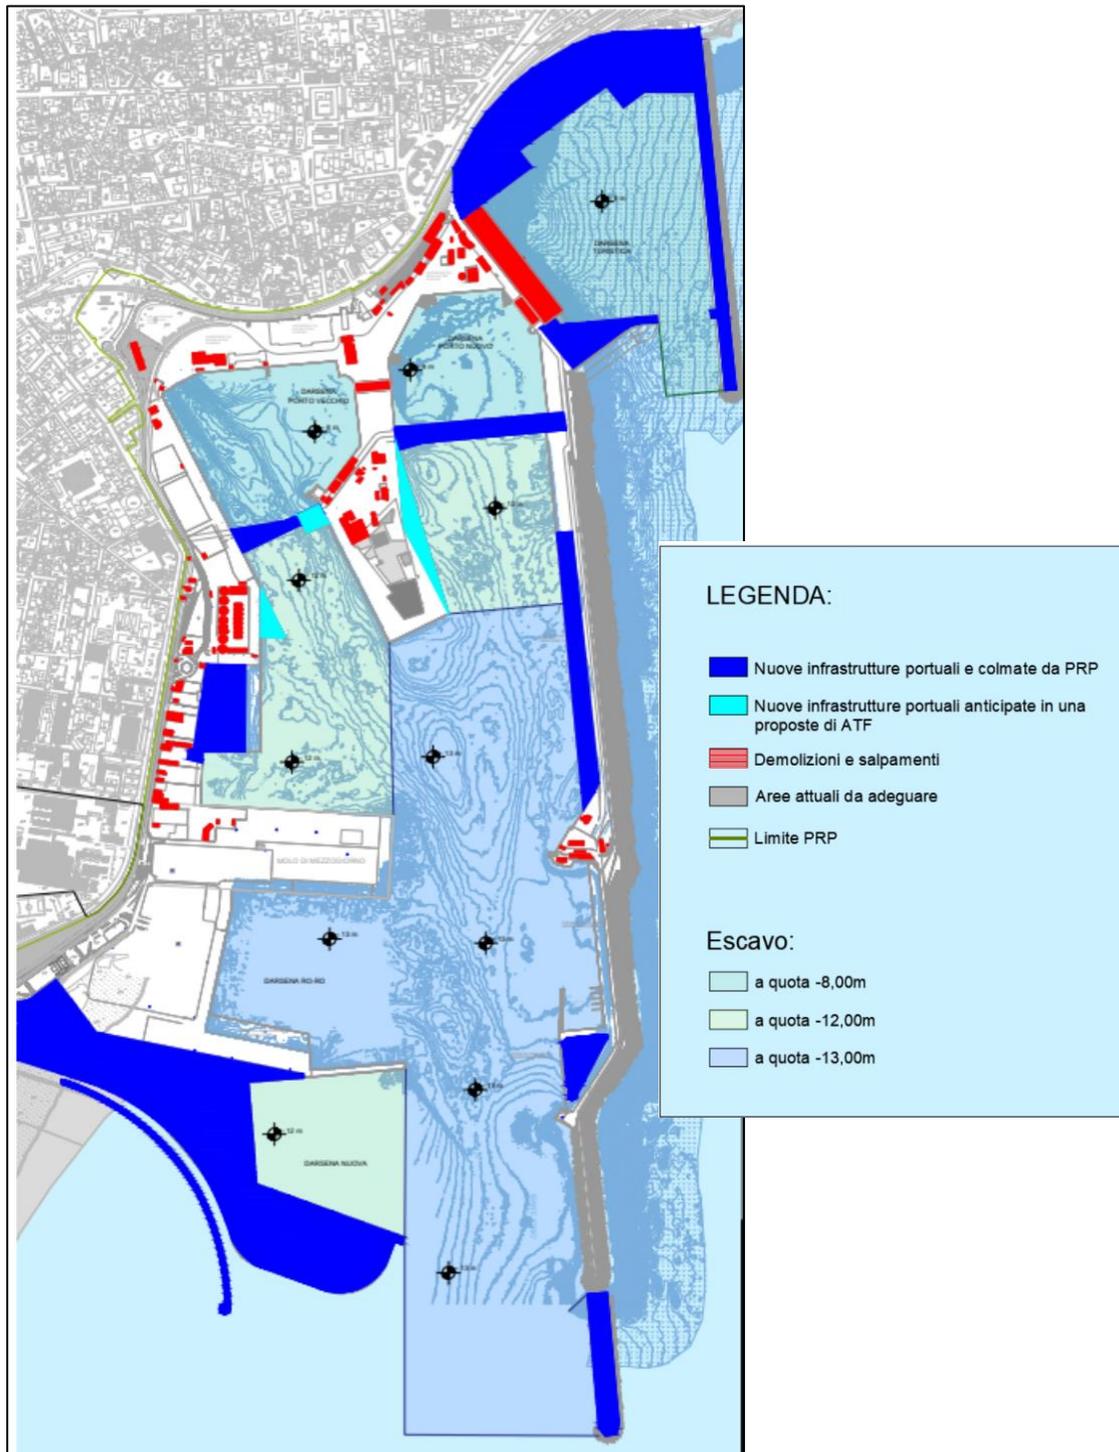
Stralcio Planimetria "Infrastrutture ed Opere"
